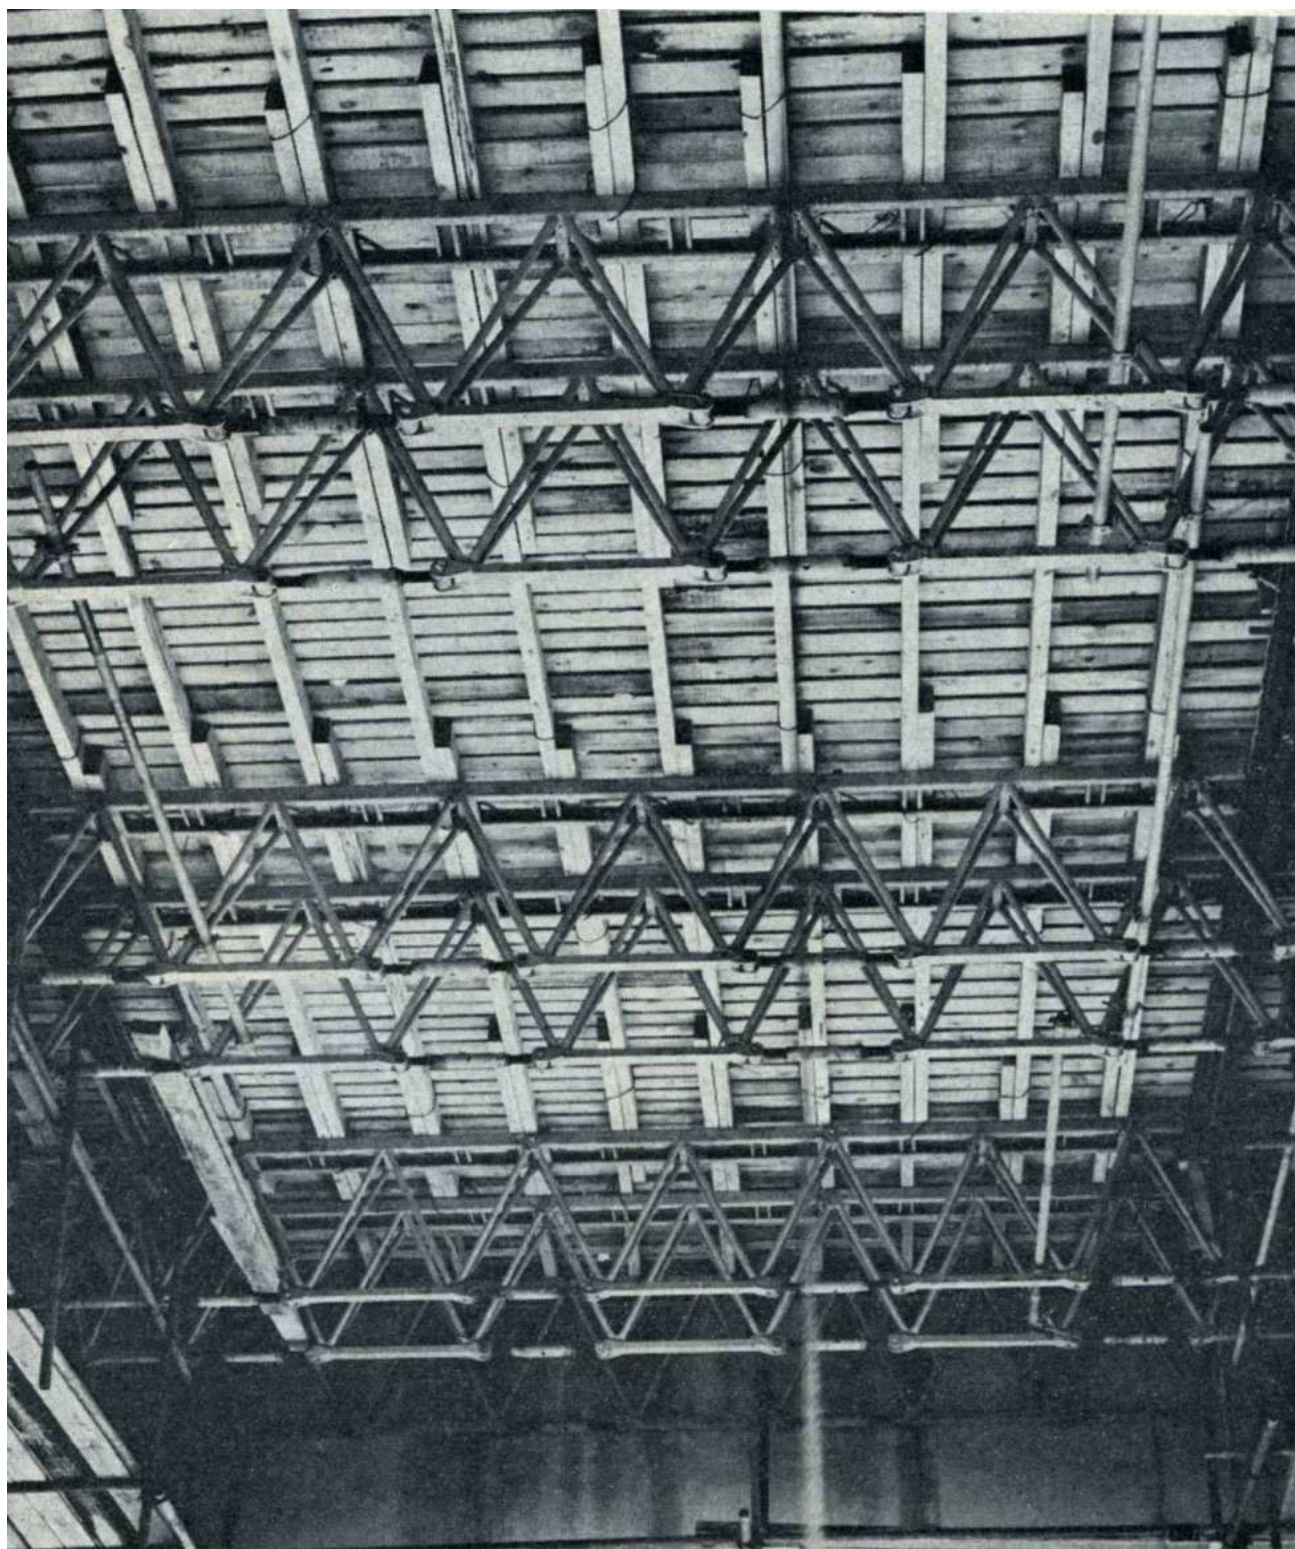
Vue d'un plateau coulissant servant de support au coffrage des planchers.
